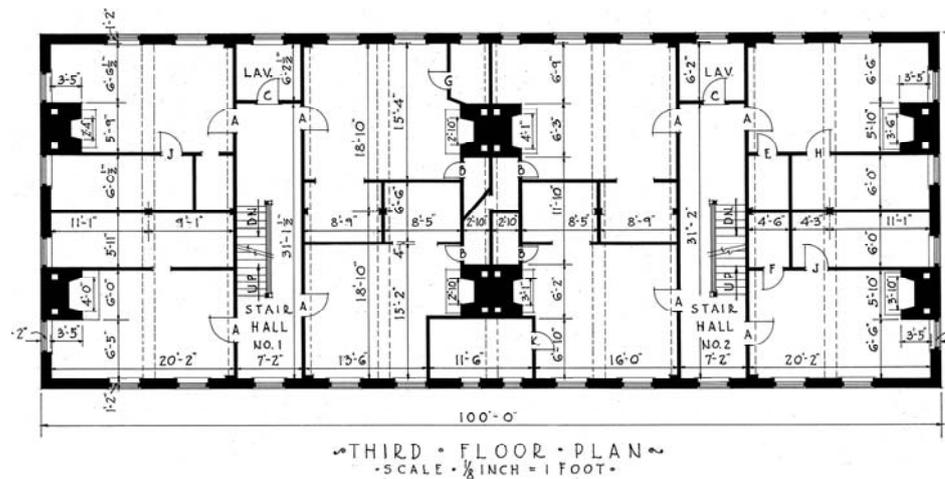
6: Connecticut Hall, Grundriss 3.Geschoss, Anordnung der Studentenzimmer nach Umbau
